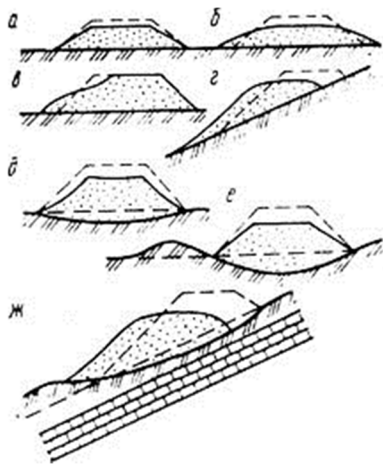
Виды деформаций насыпей: *a* – осадка от уплотнения грунта в теле насыпи; *б* – деформация осадки от растекания переувлажненного грунта; *в* – оползание откоса насыпи; *г* – сползание насыпи по косогору; *д* – осадка со сжатием грунта основания; *е* – осадка, а иногда боковое смещение из-за выжимания слабого основания; *ж* – смещение из-за оползания склона
